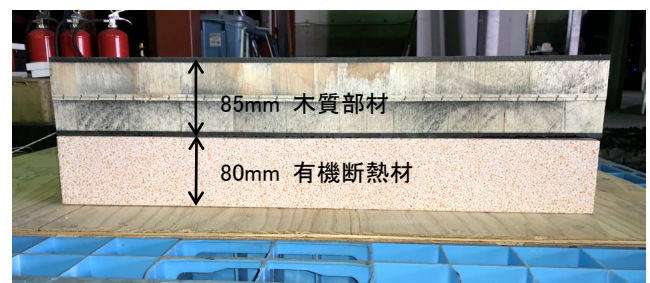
試験体側面 (平面寸法 600mm×600mm)
